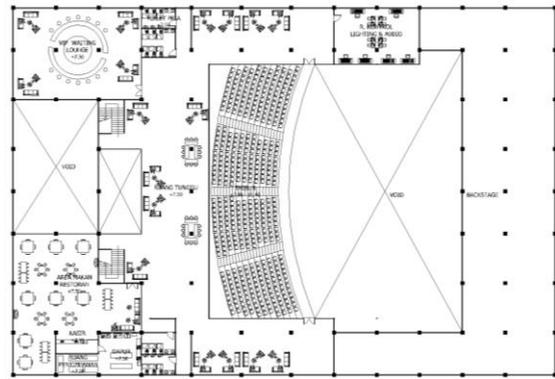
Denah Lantai 1 Gedung Pertunjukan
